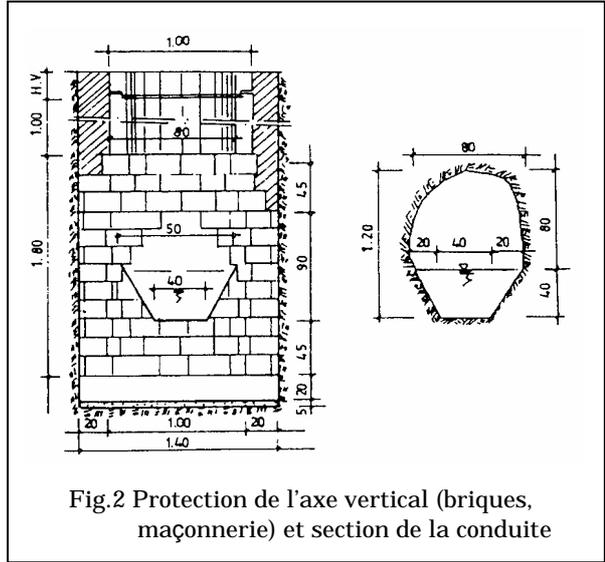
Protection de l'axe vertical (briques, maçonnerie) et section de la conduite
